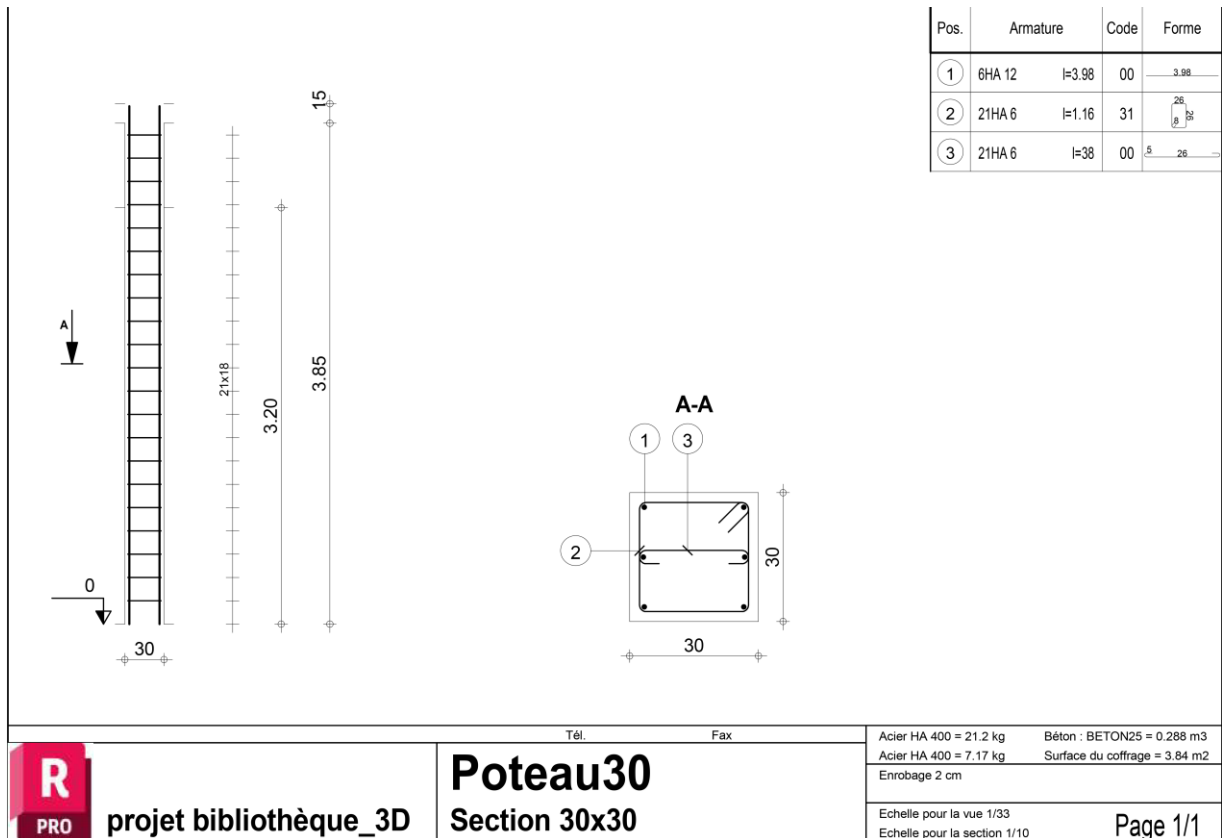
Plan d'exécution du poteau le plus chargé.
